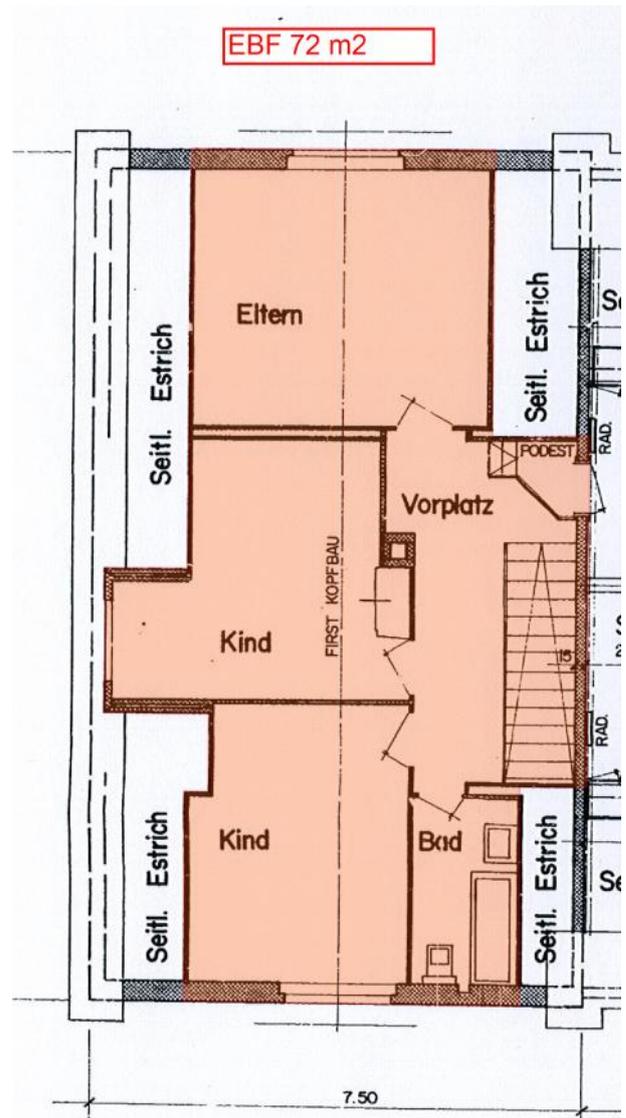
Grundriss OG, nicht massstäblich
